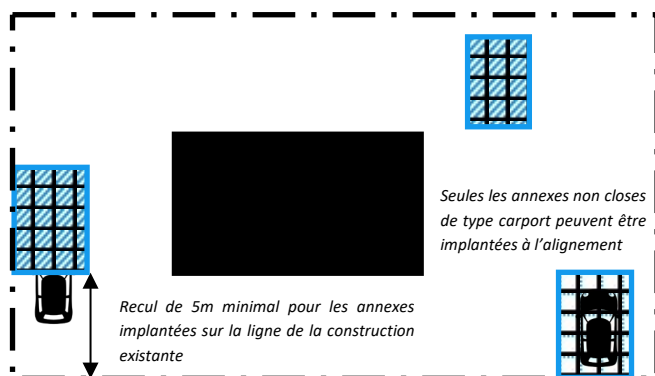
zones d'implantation possibles pour les annexes de la construction existante.
